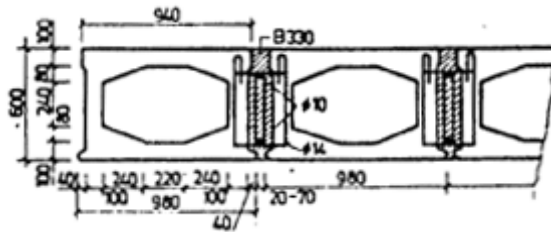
Priečný rez mosta z prefabrikátov typu MJ
